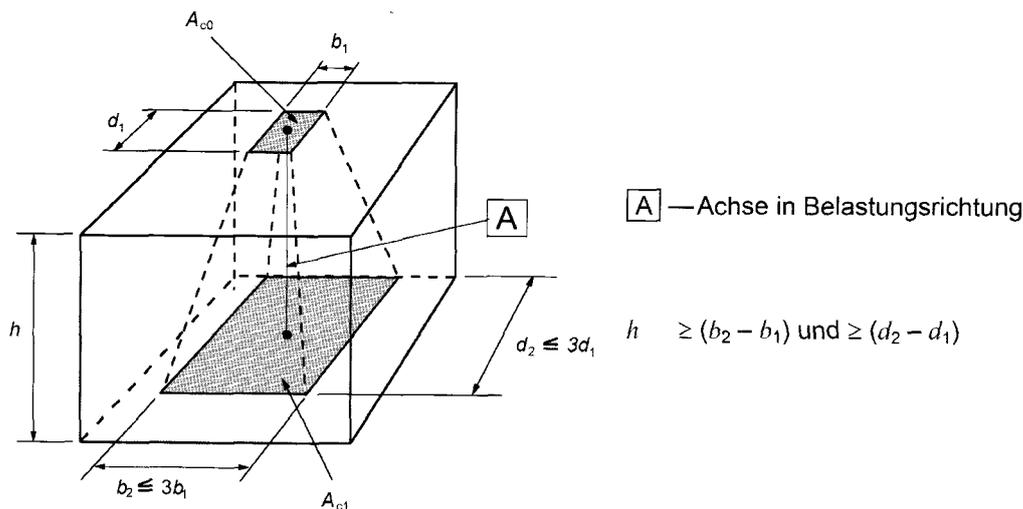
Ermittlung der Flächen für Teilflächenbelastung
